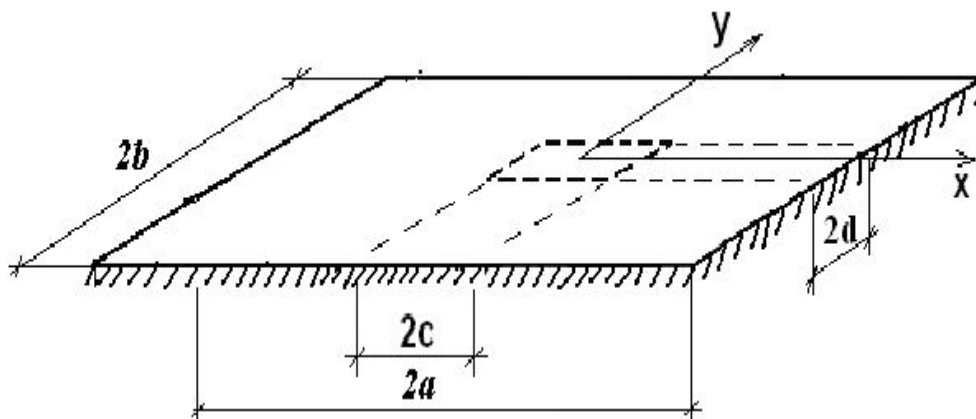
Расчетная схема прямоугольной плиты на упругом основании с отверстием в виде прямоугольника расположенного в центре под плитой
